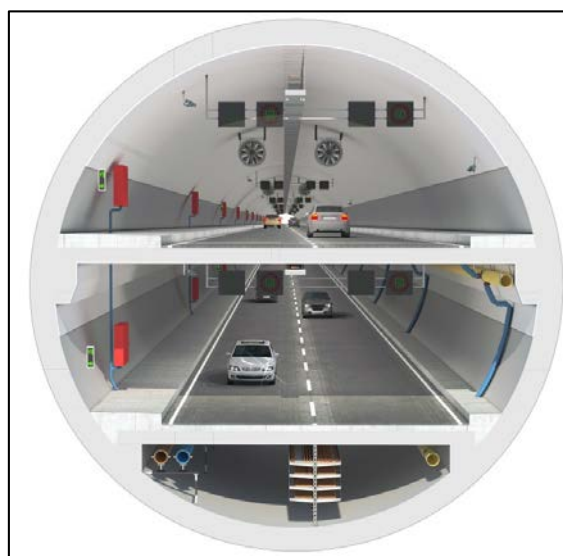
Sección de túnel carretero con dos calzadas en altura, sistemas de ventilación mediante jet fans independientes y galería inferior de instalaciones.
